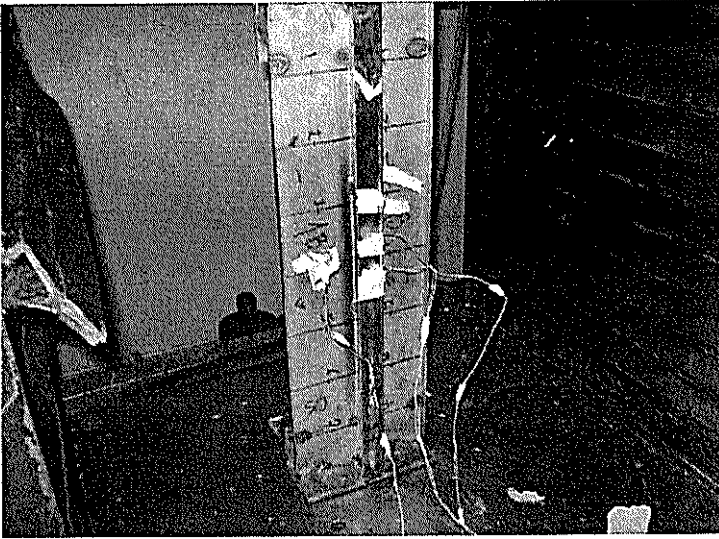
Espécimen N° 5, con los extensómetros.
